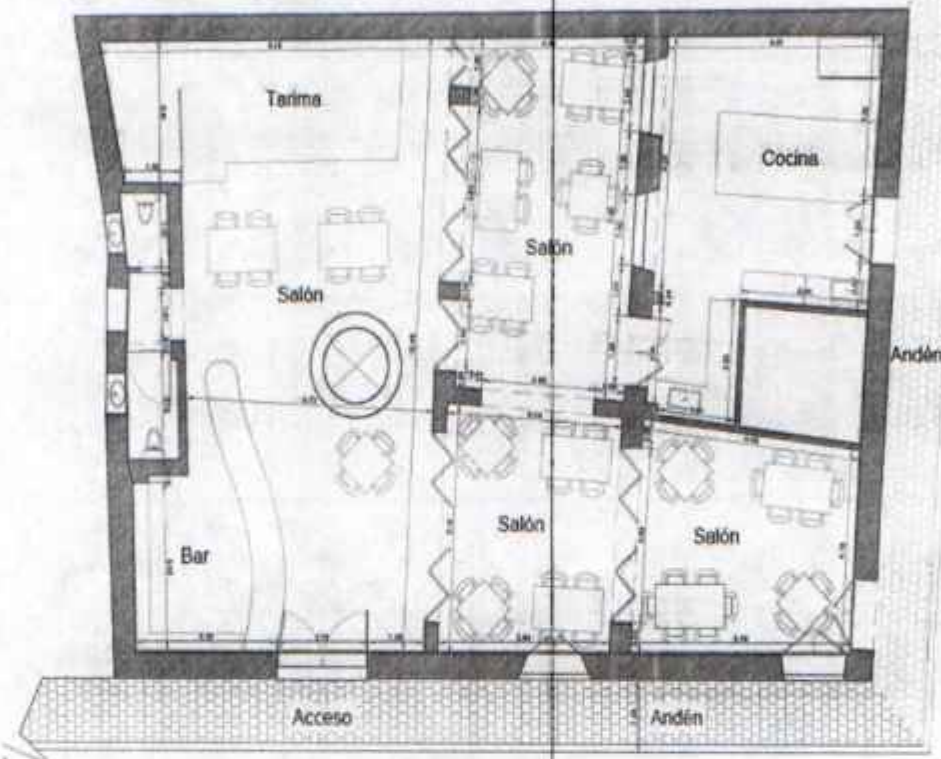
Plano JUAN DEL MAR RESTAURANTE -Área privada
